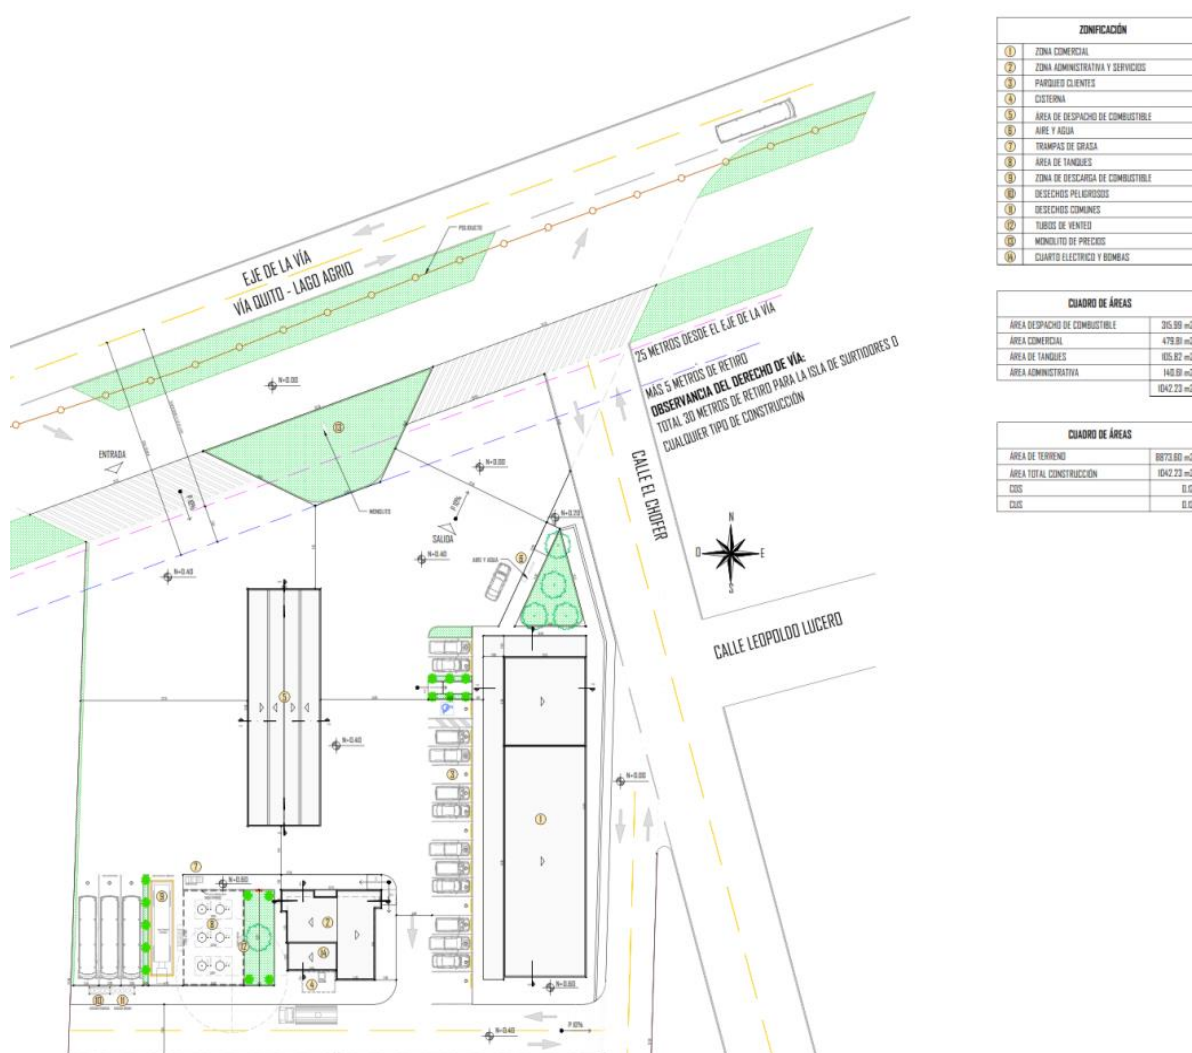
Zona de áreas verdes Fuente: Plano arquitectónico
